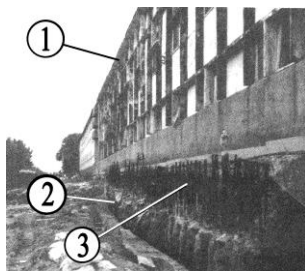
Приклад влаштування підпірної стінки фундаментів із ГЦЕ, підсилені арматурними каркасами: 1 – будівля реконструкції; 2 – ГЦЕ; 3 – арматурні каркаси
